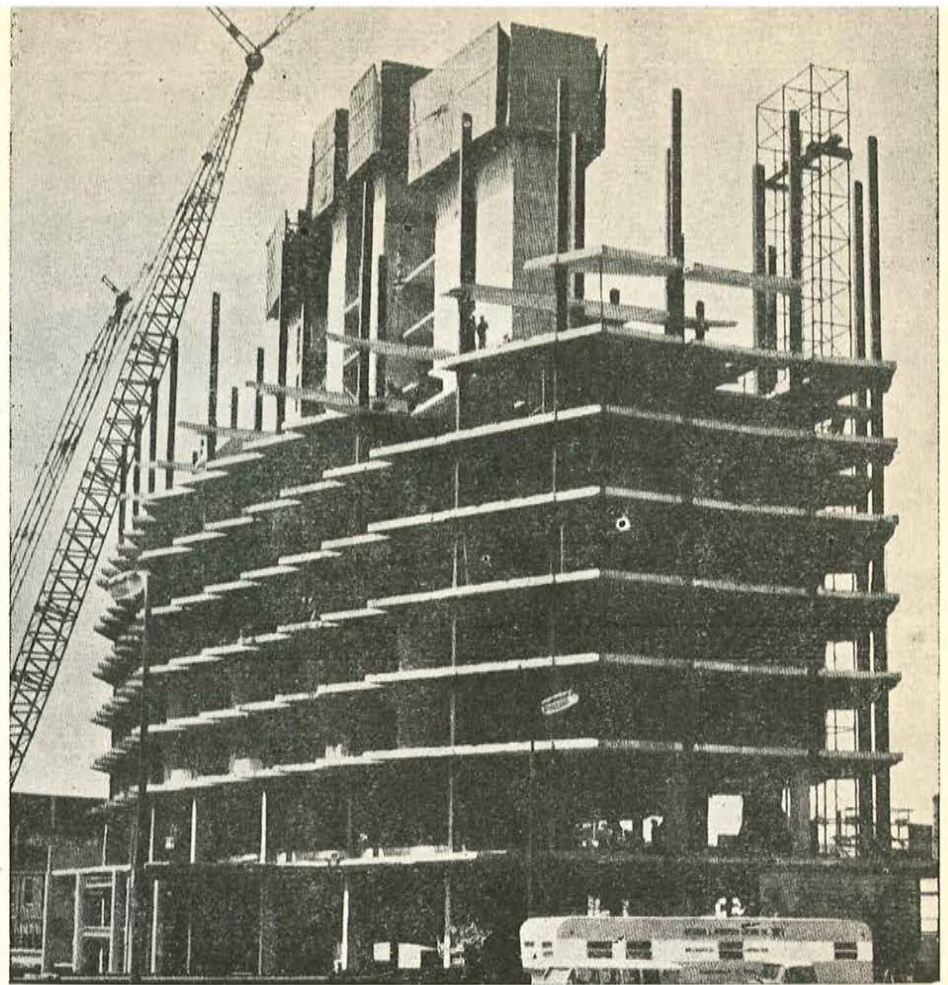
Vista de conjunto de la estructura, completa en sus elementos horizontales; se han colocado ya los primeros paneles verticales de fachada.
